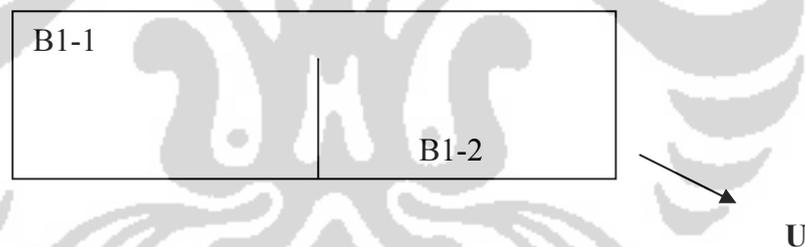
Denah Lantai dasar bangunan B (Dok: pribadi)
